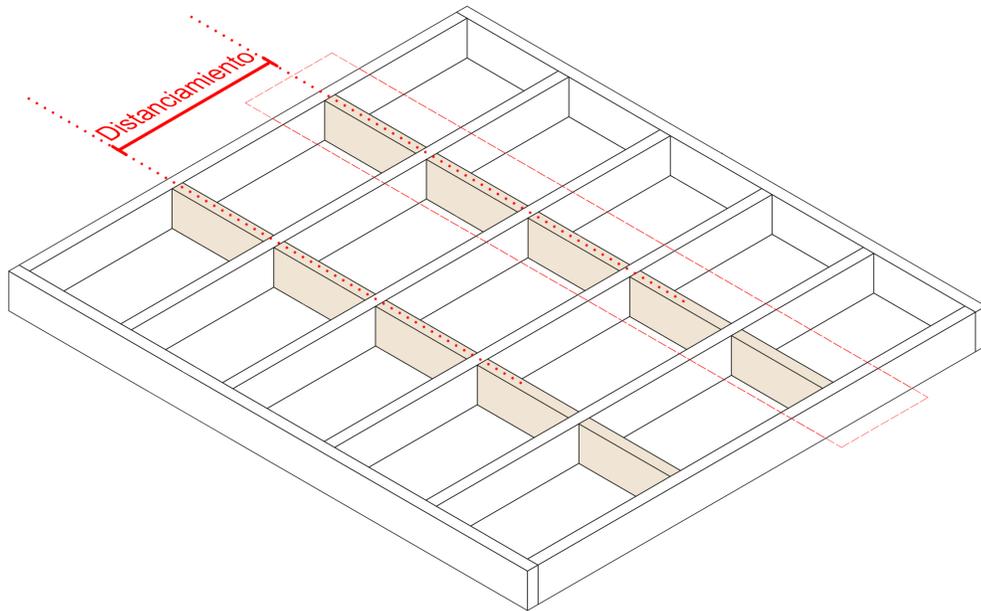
Distanciamiento de una cadeneta en un elemento constructivo horizontal
